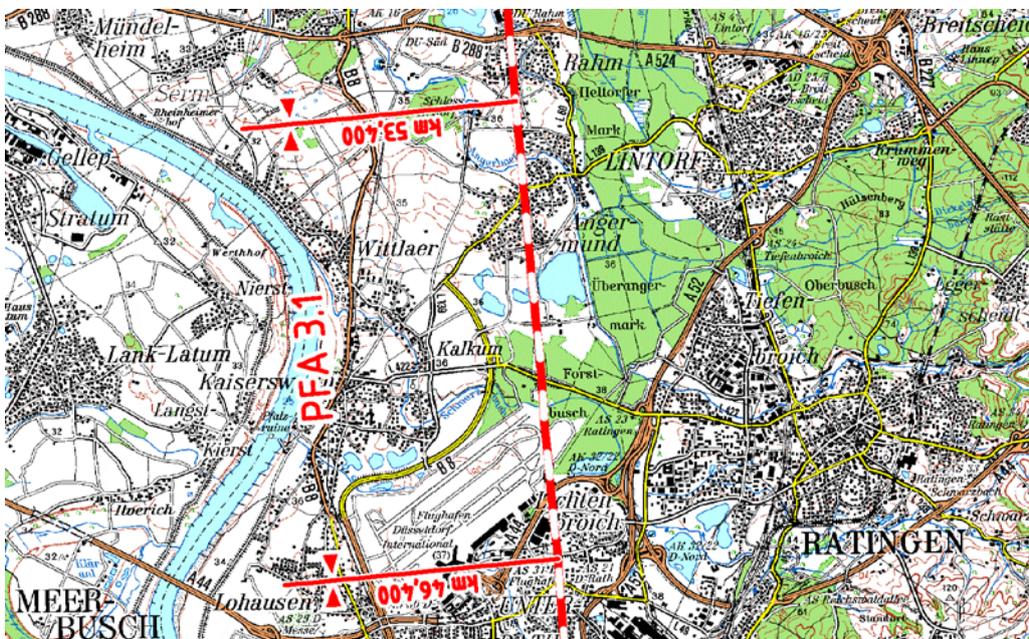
Übersichtslageplan Planfeststellungsabschnitt 3.1 [28]
